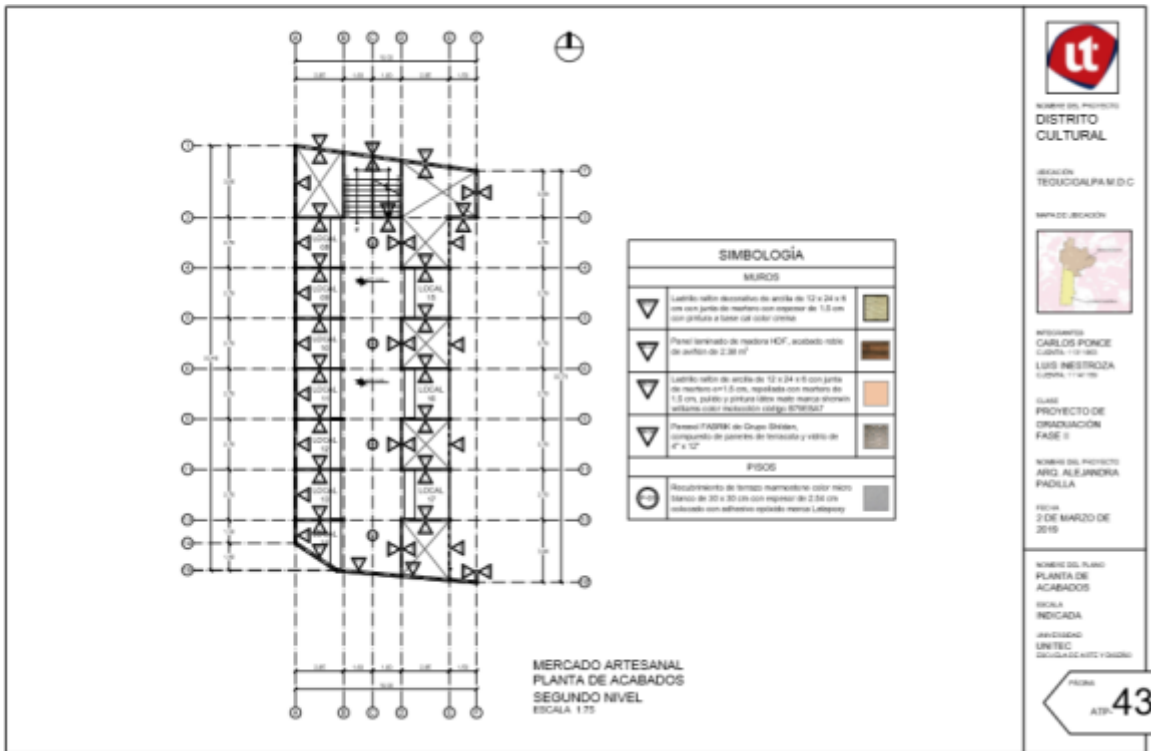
Planta de Acabados Mercado Artesanal Segundo Nivel
